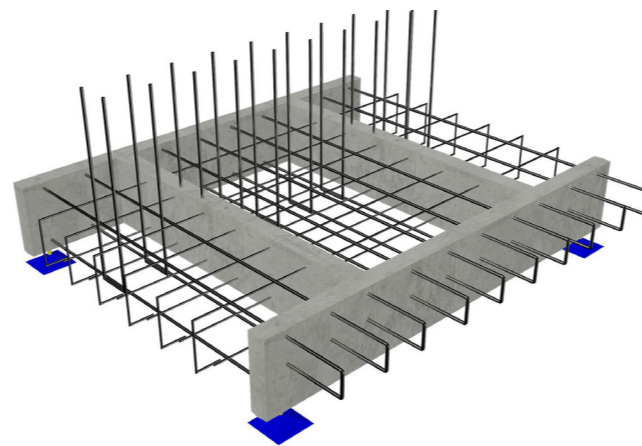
Imágen Sistema Estructural Hormigón Armado. Tomado de Google Imágenes, s.f.
